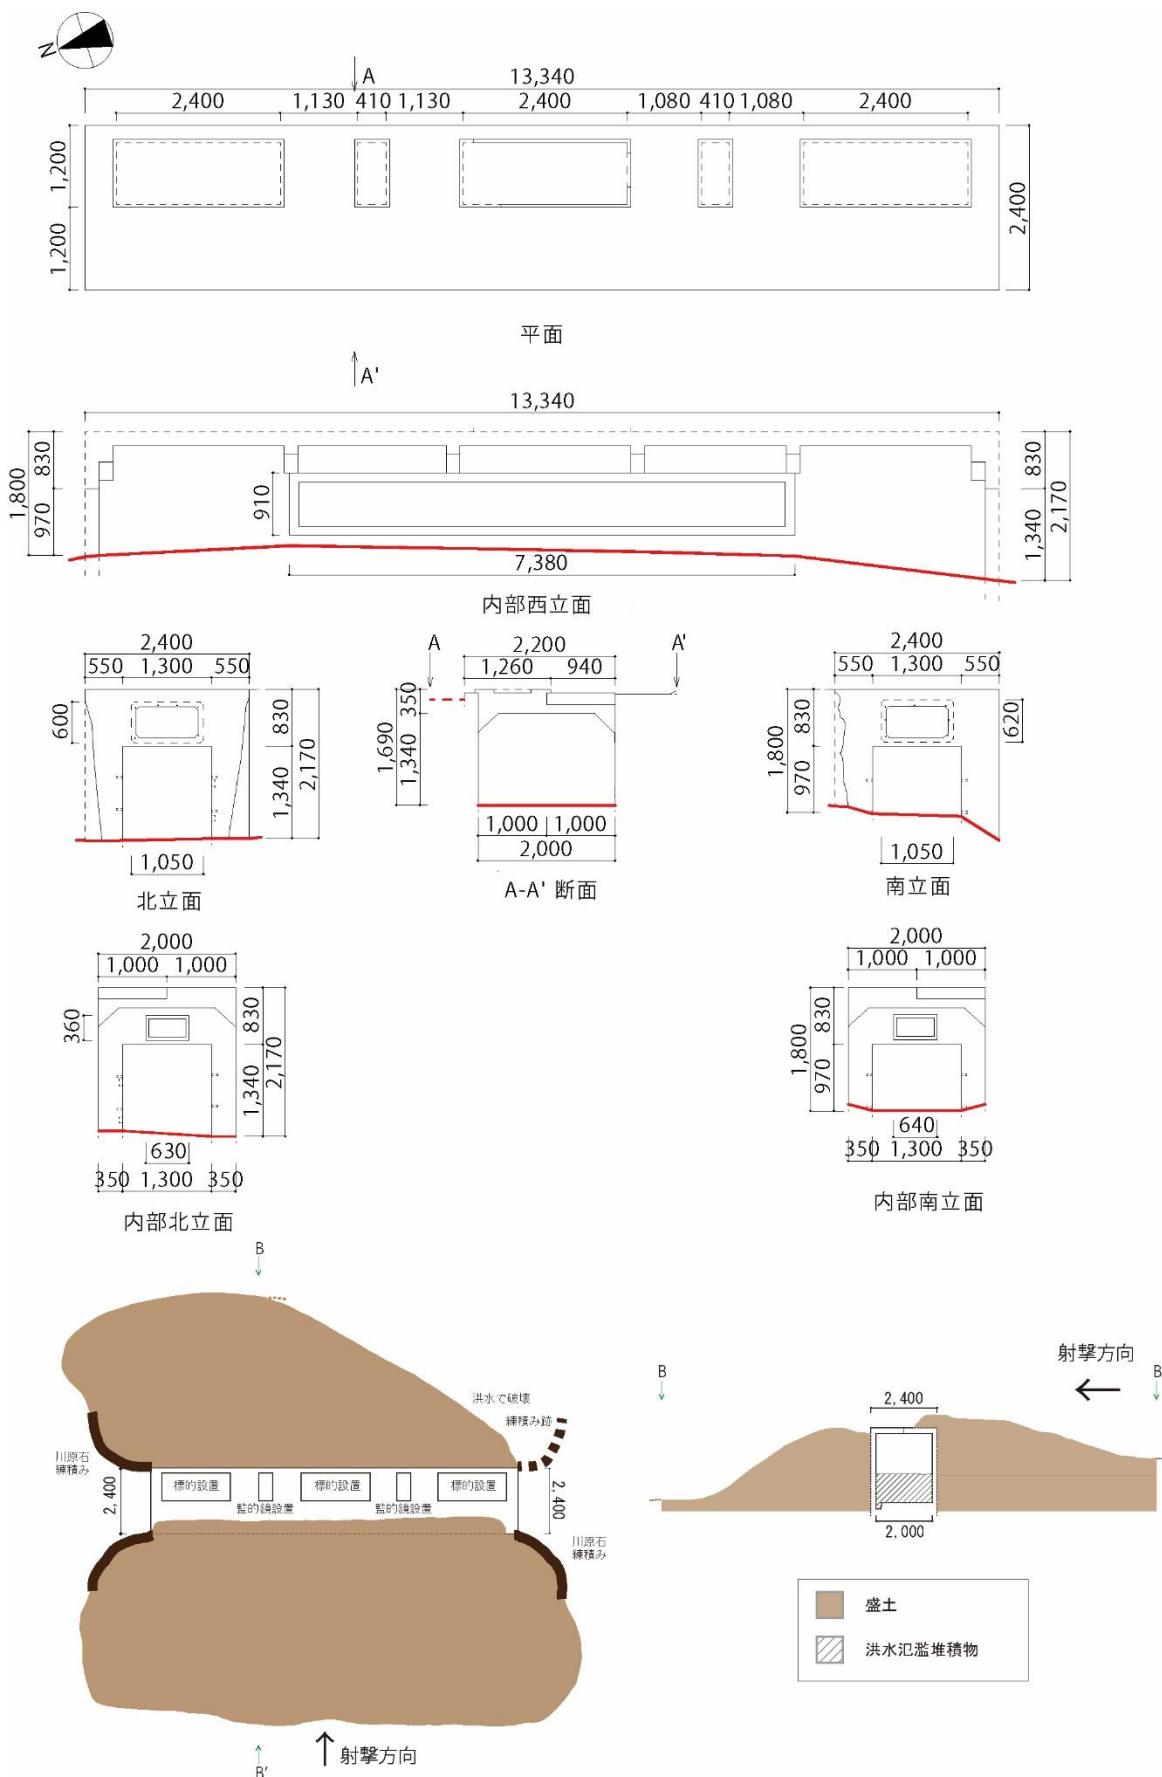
山部村分会小銃射撃場監的壕の平面・立面・断面図
